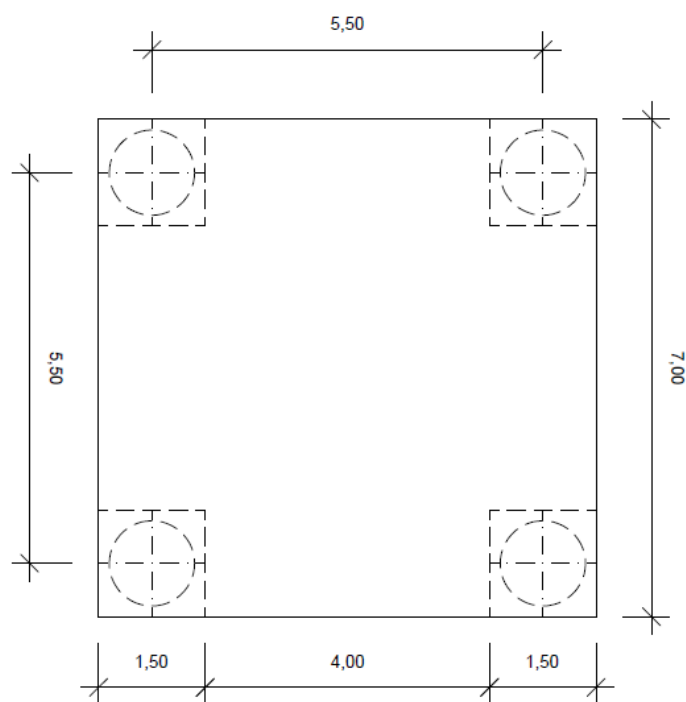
Disposición de los pilotes en el duque de alba de nueva construcción.
